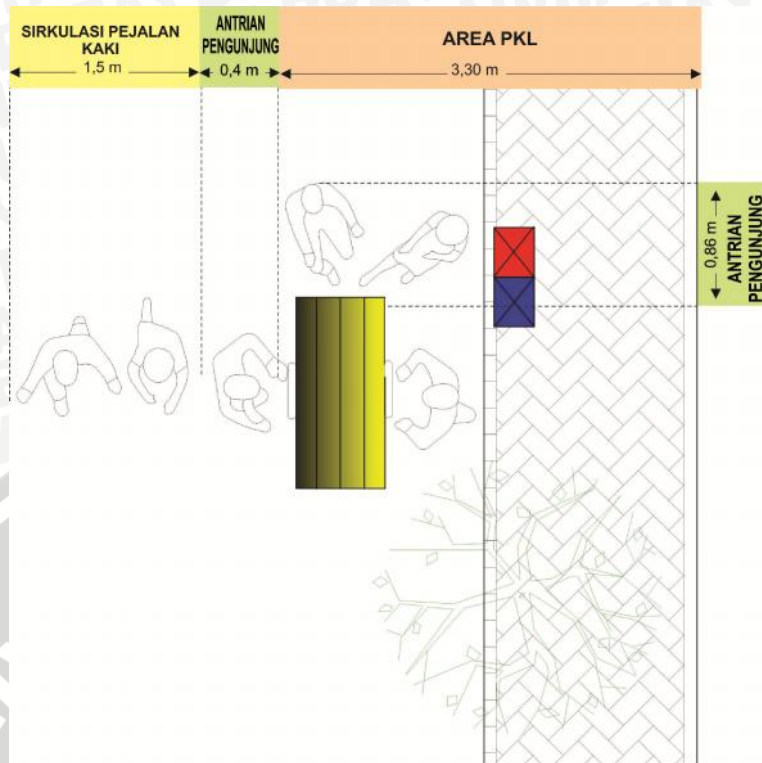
Arahan Dimensi Ruang Alat/ Sarana Berdagang Jenis Tenda (Tampak Samping)
